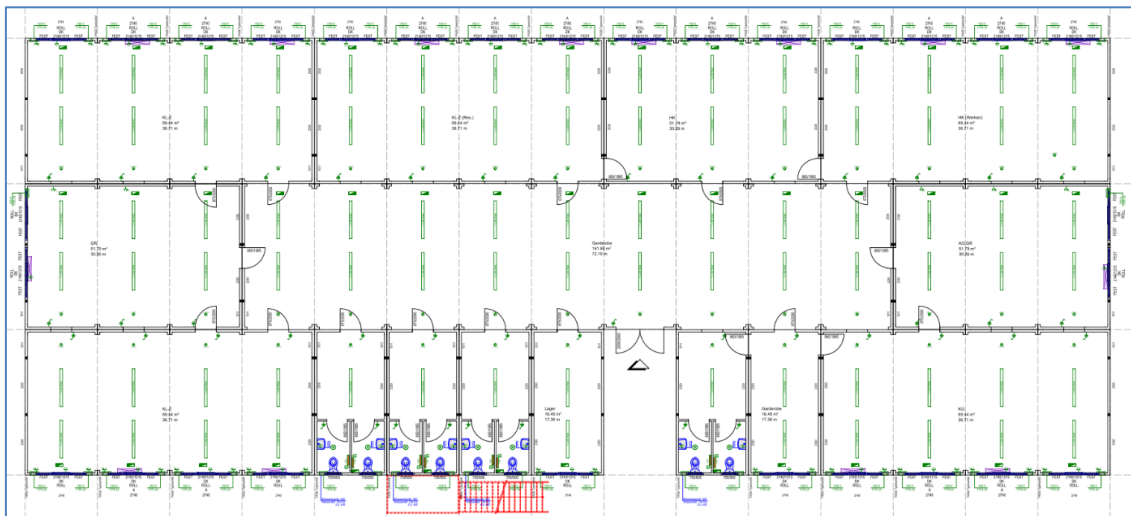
Grundriss der Containeranlage (Variante der Firma Fagsi AG, Wikon)
